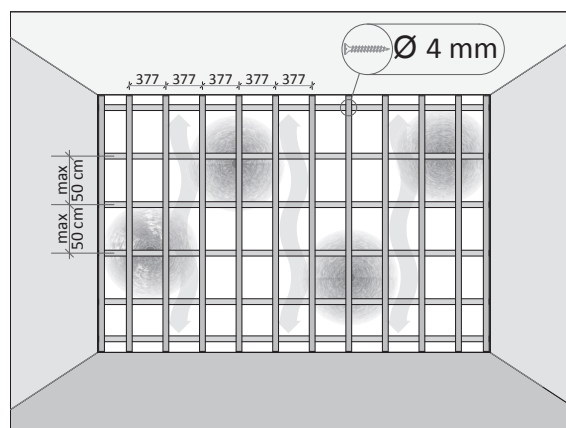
Монтаж первого элемента на планках – монтаж по вертикали.
